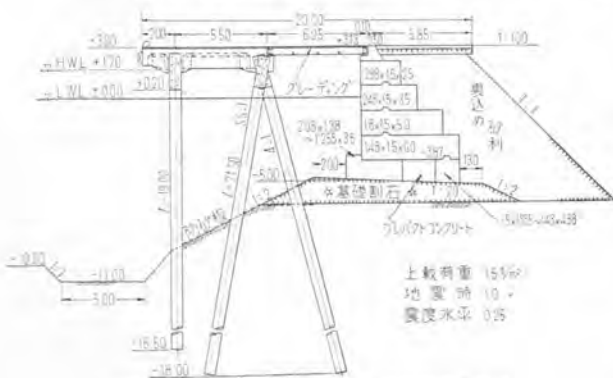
興津第一ふ頭 -10 m 岸壁標準断面図
